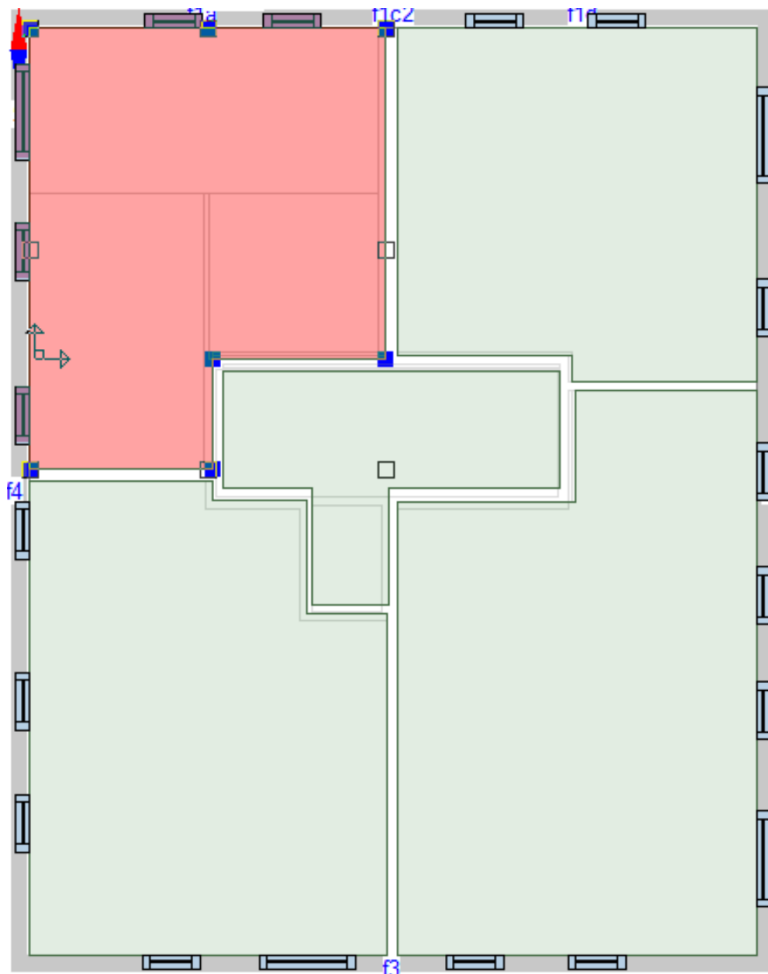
Grundrissmodell einer Wohneinheit
